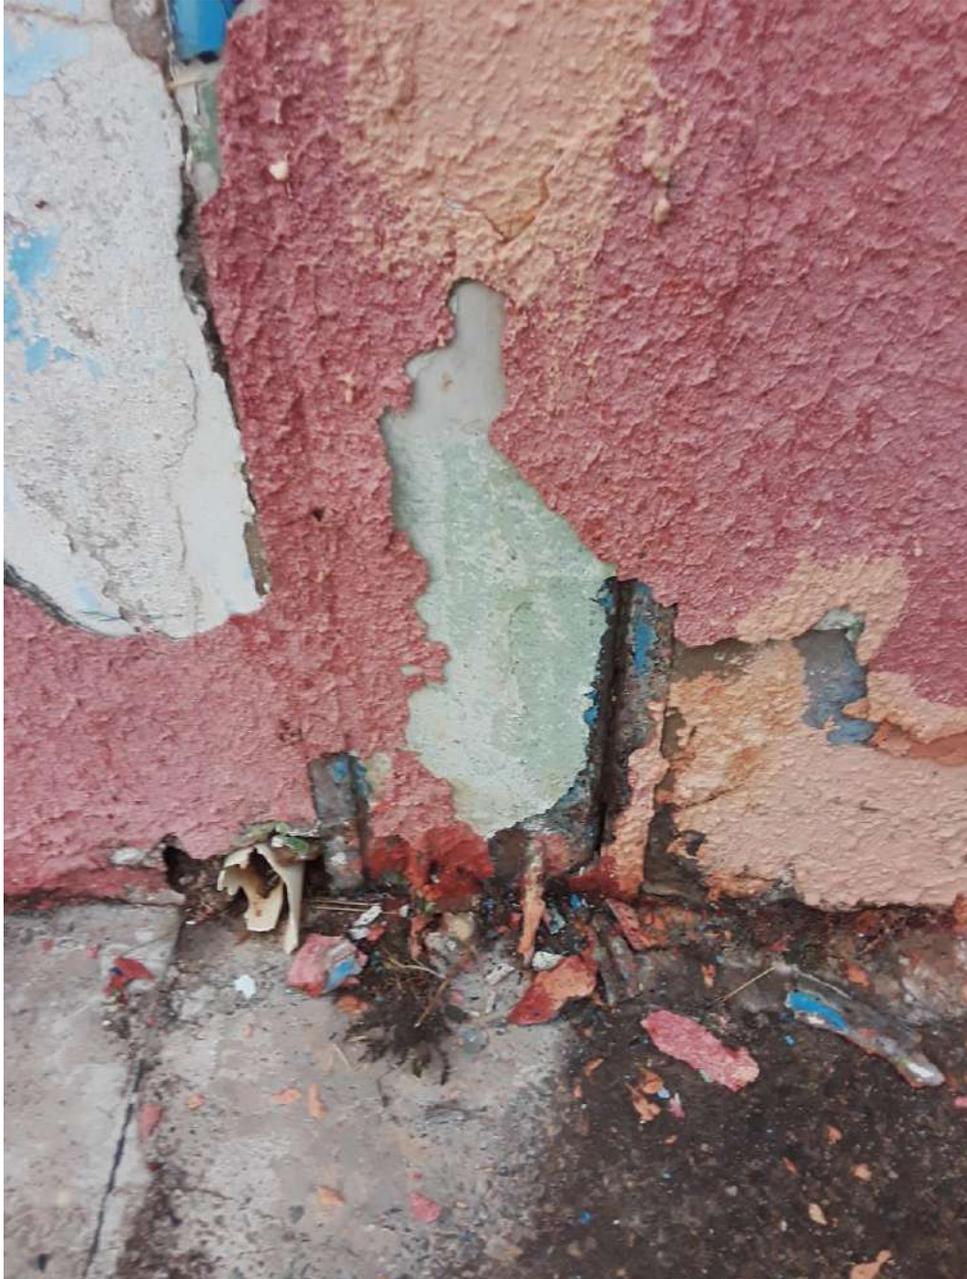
Base do Pilar 03 com corrosão grau C na área externa
